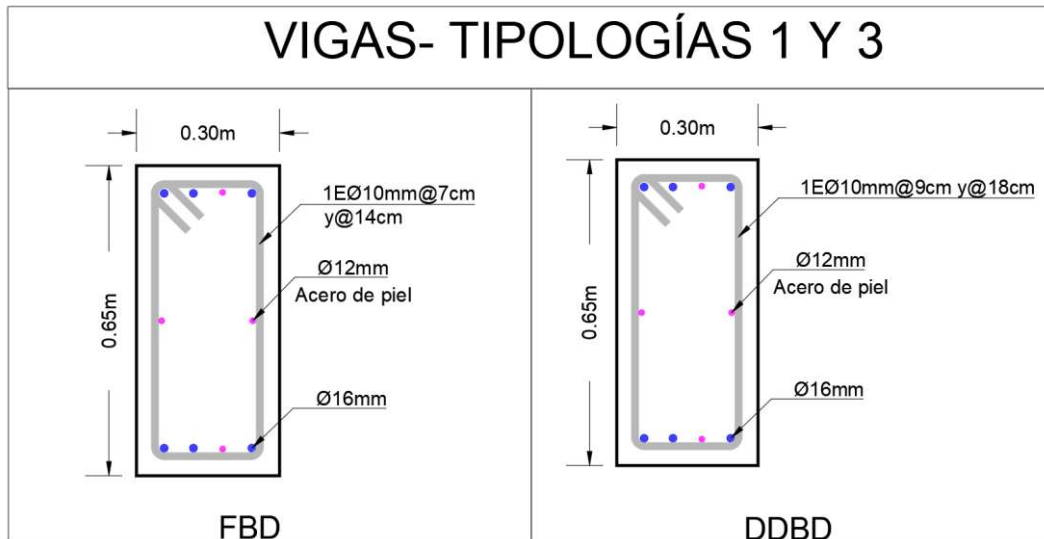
Esquema de vigas tipologías 1 y 3
